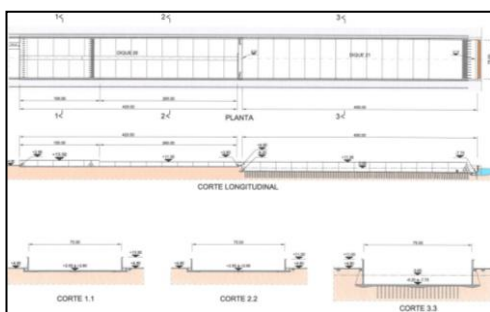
Planta e cortes-tipo das docas 20 e 21
